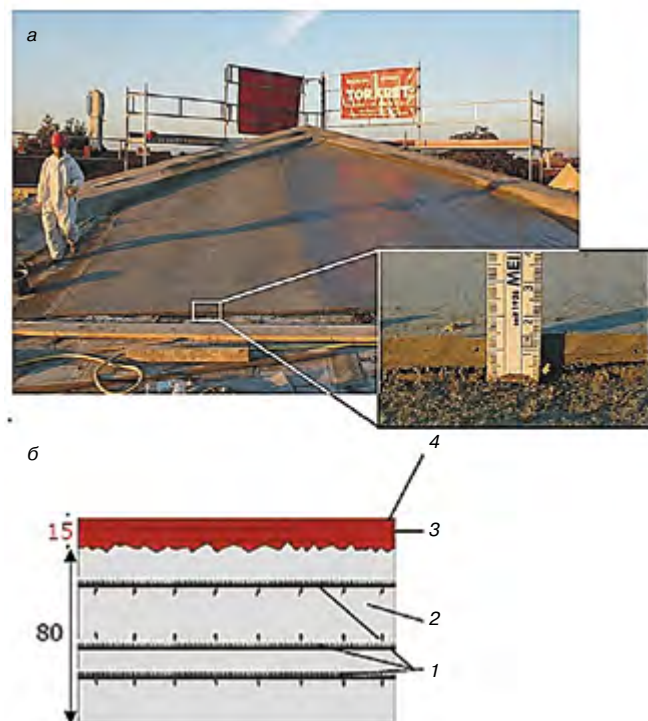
Уложенный текстиль-бетон (а) [9] и схема усиления текстиль-бетоном (б): 1 – стальная арматура; 2 – старый бетон; 3 – слой текстильной сетки; 4 – слой мелкозернистого бетона
